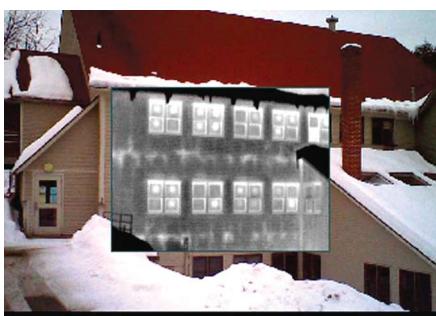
Многочисленные теплые области на наружной фасадной стене коммерческого здания связаны с неправильной установкой теплоизоляции из стекловолокна.
